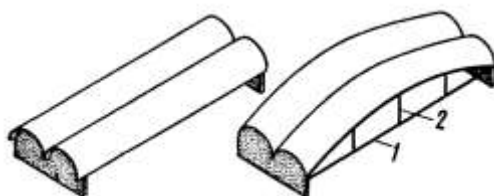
Цилиндрическая и бочарная оболочки: 1 - затяжка; 2-подвеска [103]
